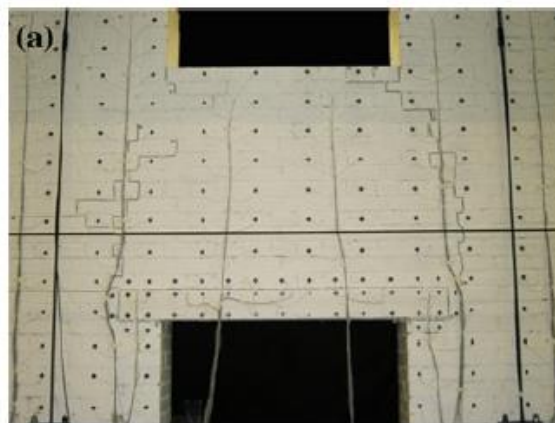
Patrón de agrietamiento al inicio de la fisuración, grietas de flexión a través de las juntas (Katrin Beyer & Dazio, 2012).
